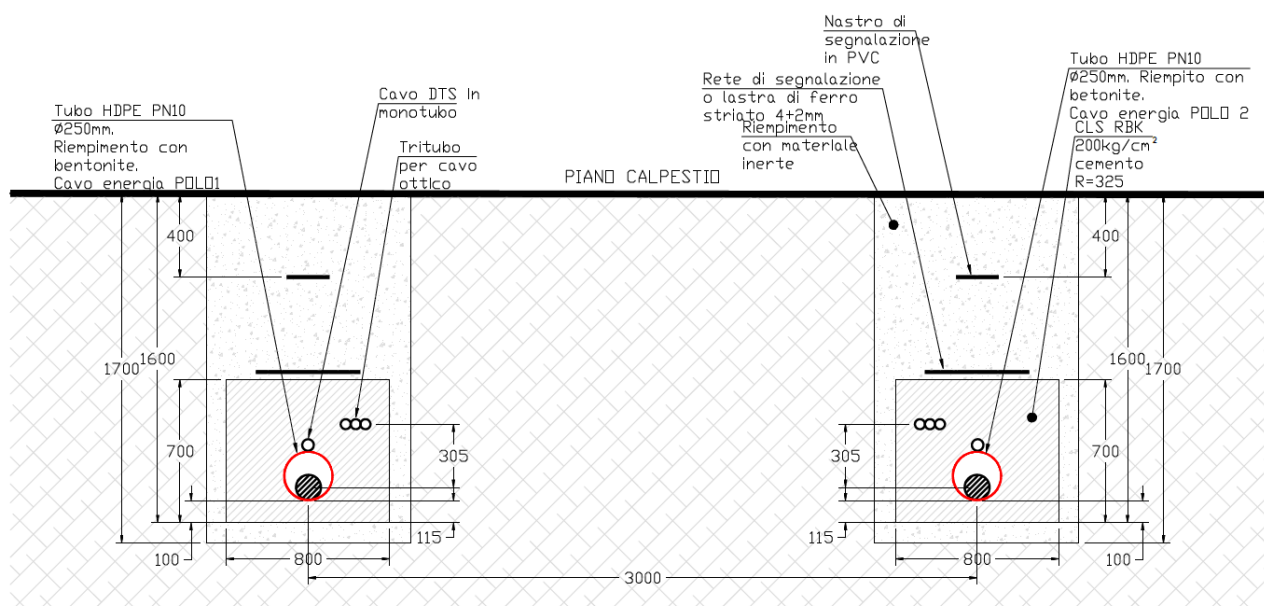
Schema della sezione di posa dei cavi e delle apposite tubiere
